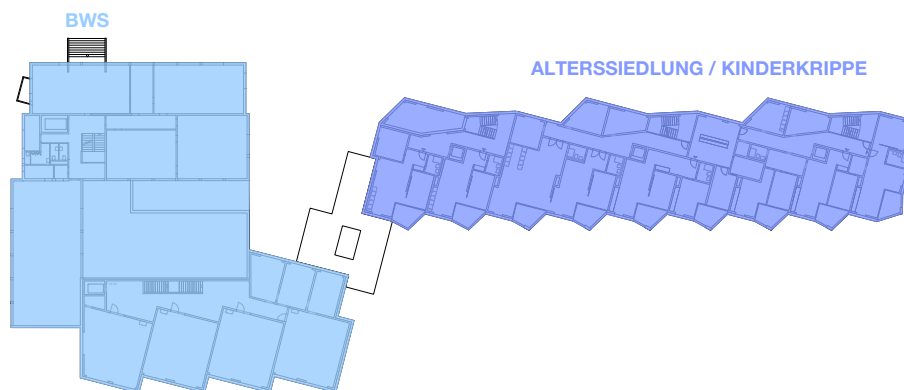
Grundriss Gartengeschoss - Stand Wettbewerb November 2014
